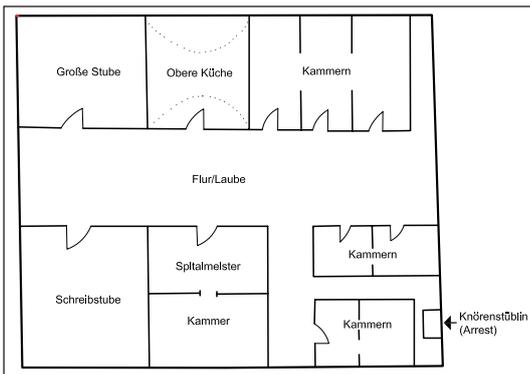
Ravensburg. Rekonstruierter Grundriss des Spitalgebäudes nach archivalischen Belegen des 16. Jahrhunderts. Erstes Obergeschoss.
